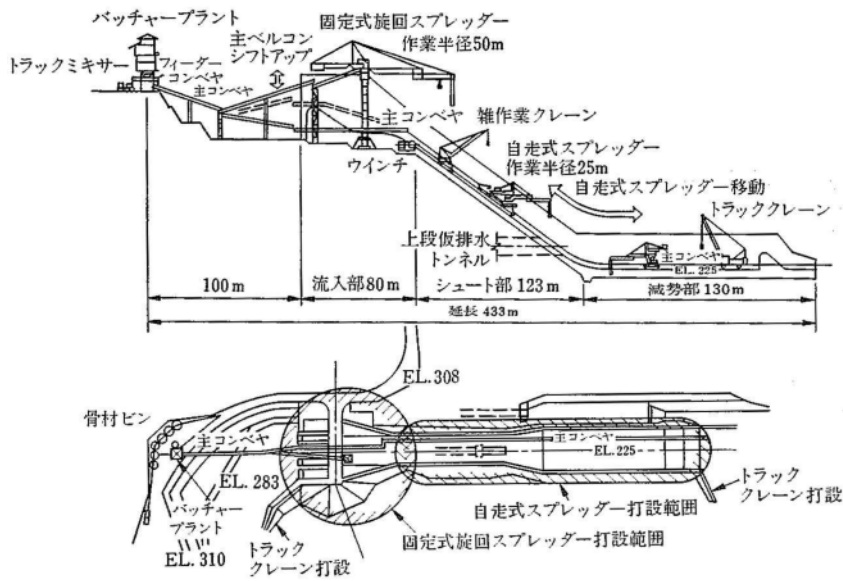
3 - 13 フィルダム洪水吐コンクリート打設 BCP 工法 (七ヶ宿ダム)
